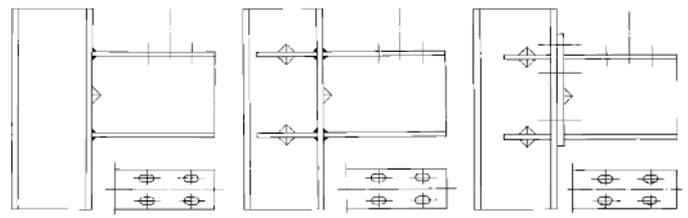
a: Geschweißte und geschraubte Kranbahnkonsolen aus Walzprofilen
